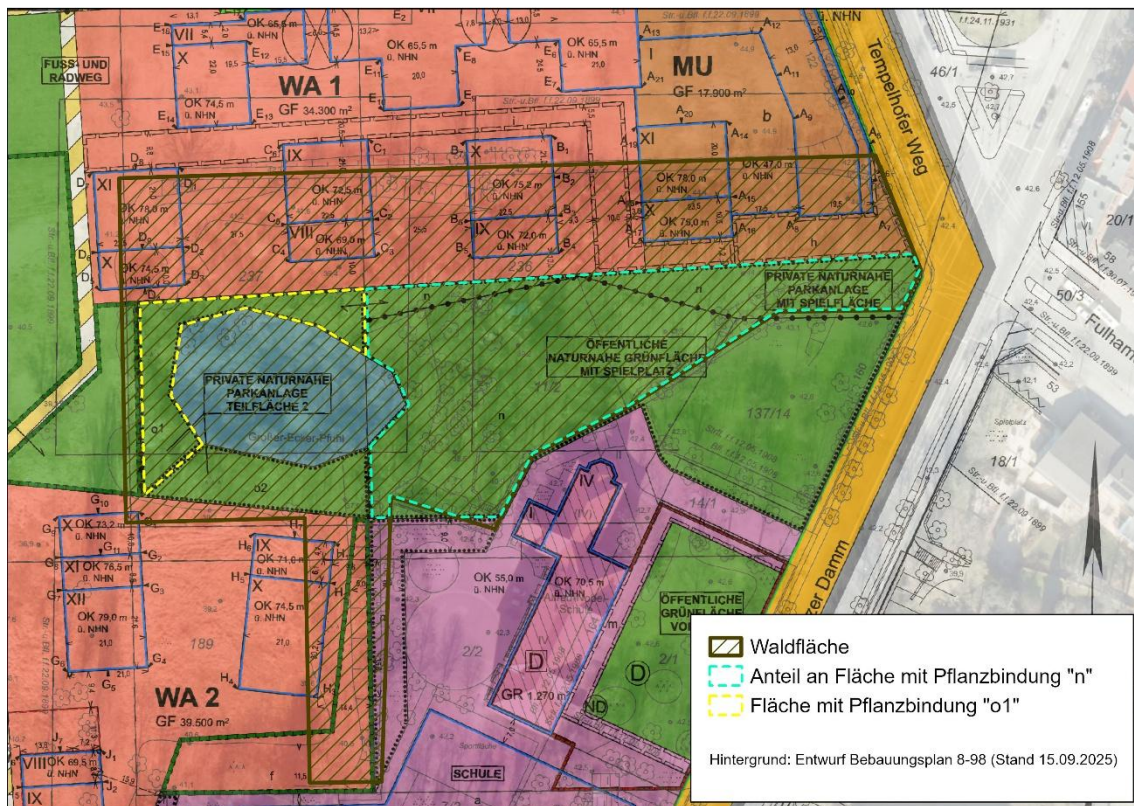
Entwurf des Bebauungsplans 8-98 (Stand 15.09.2025) mit Lage der Waldfläche nach LWaldG im Geltungsbereich und Lage der anrechenbaren Teilflächen mit Restwertigkeit
